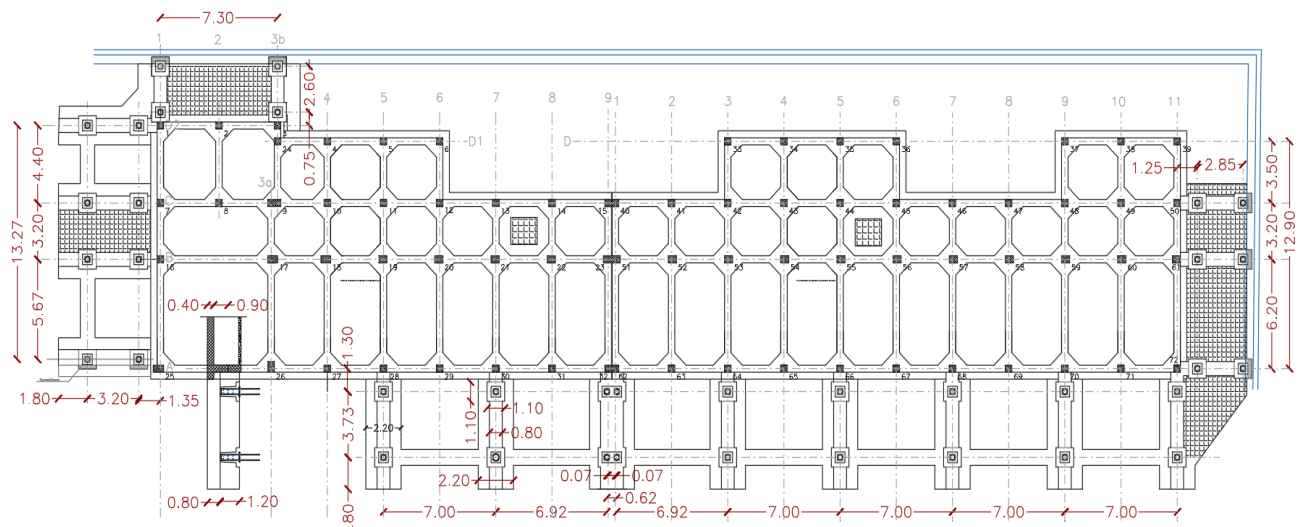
STRALCIO DELLA PIANTA FONDAZIONI ESOSCHELETRI, CON INDICAZIONE DELLE QUOTE SIGNIFICATIVE
